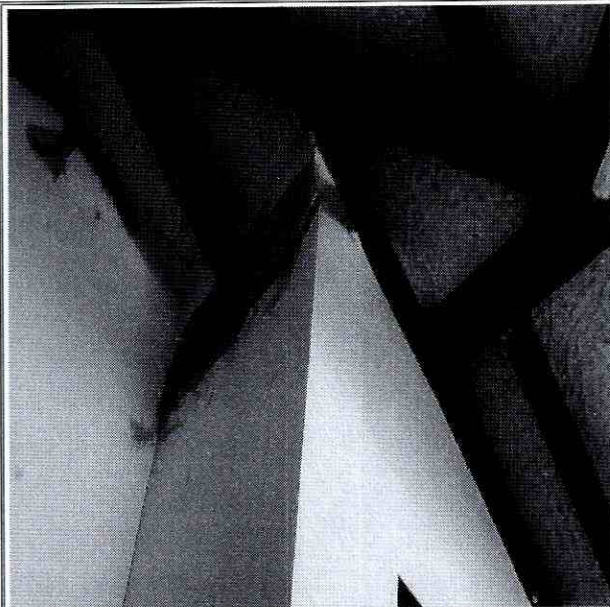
Afectaciones en el sector de la cubierta de la vivienda
